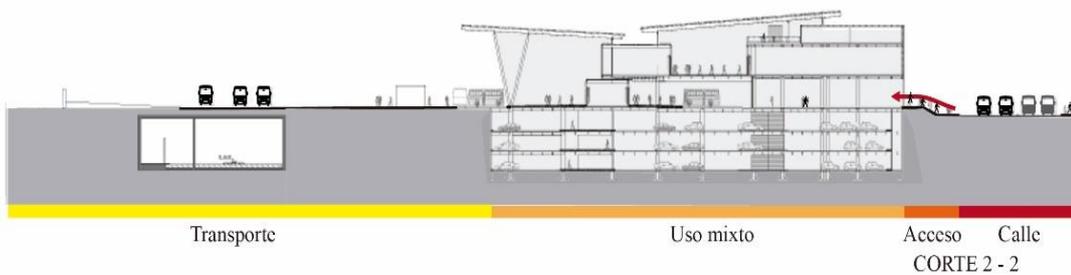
Corte 2-2 Estación Cuatro Caminos.
